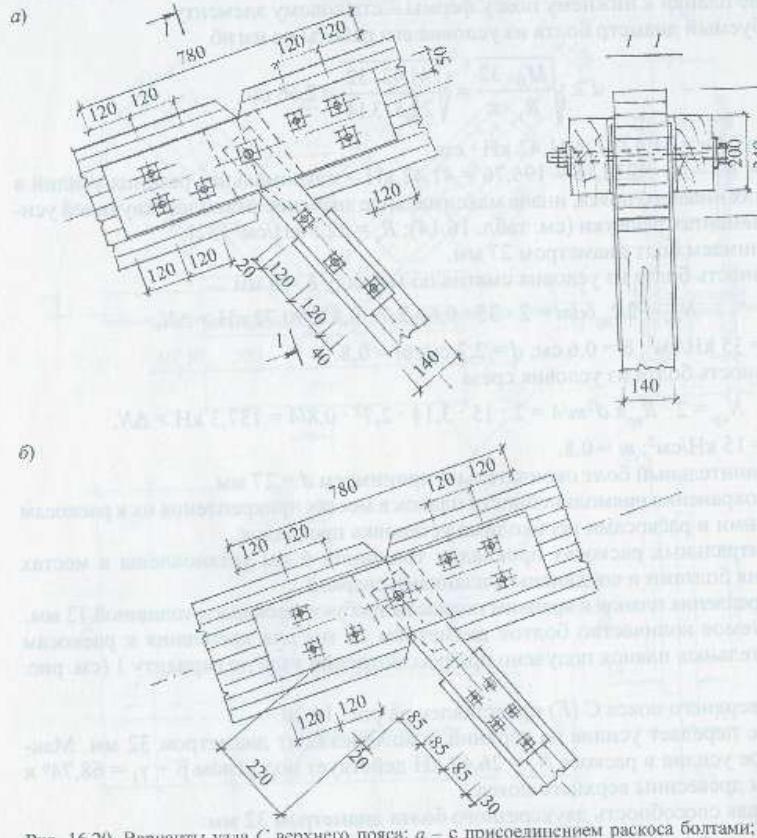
Варианты узла  $C$  верхнего пояса: а – с присоединением раскоса болтами; б – то же, гладкими винтами
